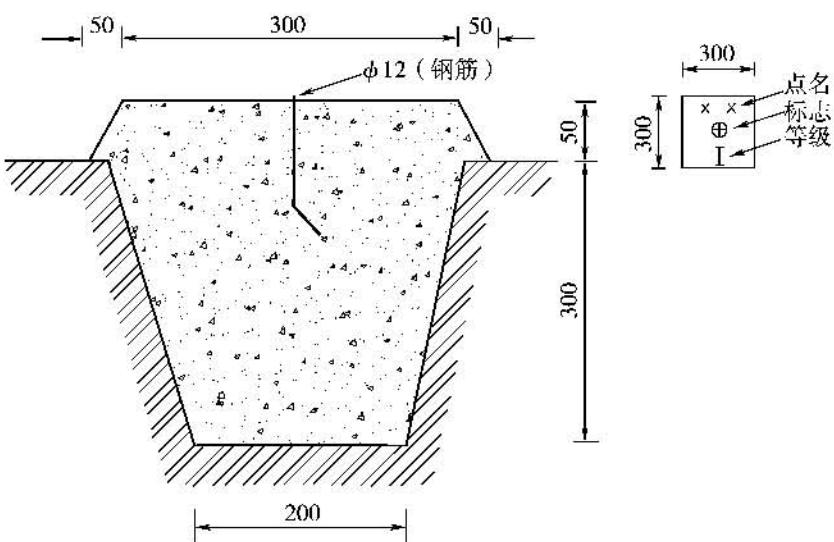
现场浇注标石示意图(单位:mm)
